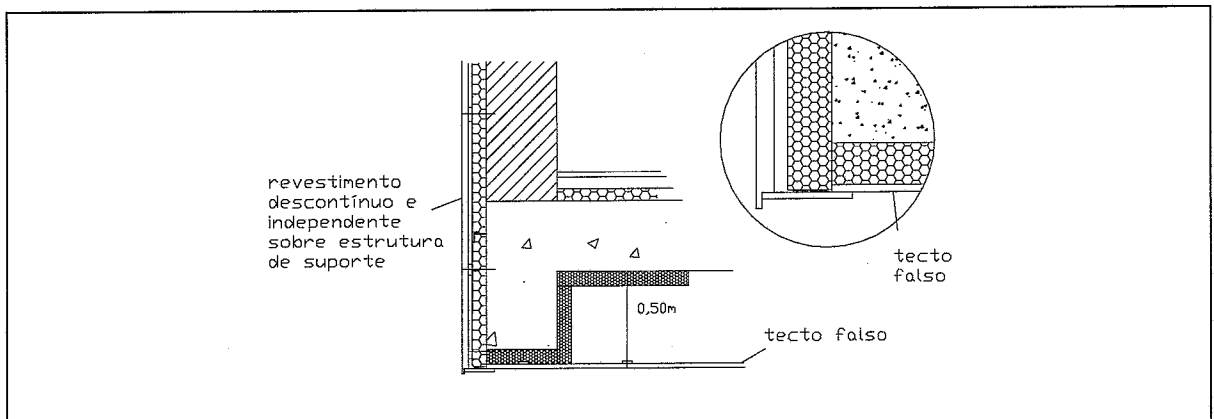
Pormenor de correcção térmica sob a laje com isolante térmico fixado e prolongado a partir do isolante térmico da parede
